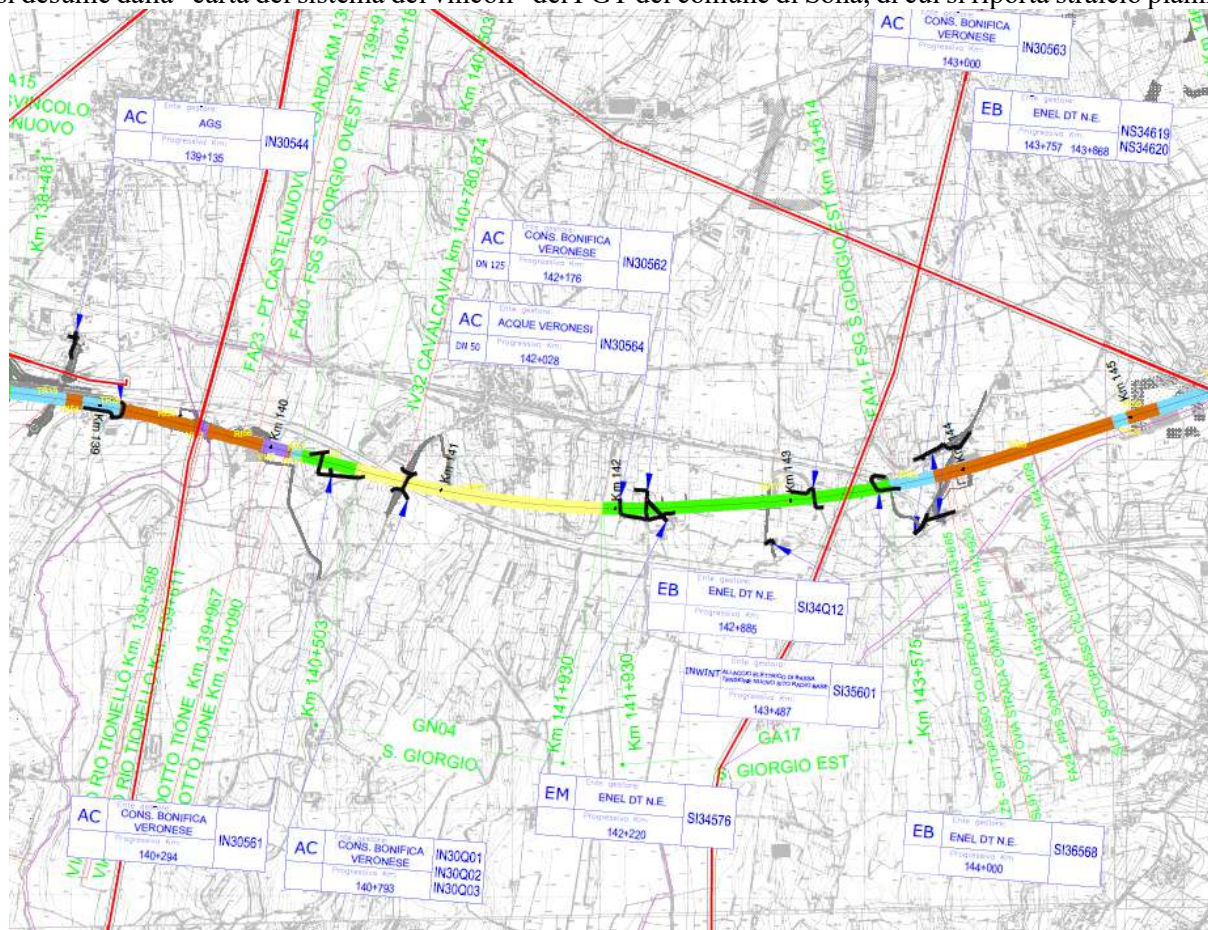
Stralcio "Carta fasce di rispetto elettrodotto"
